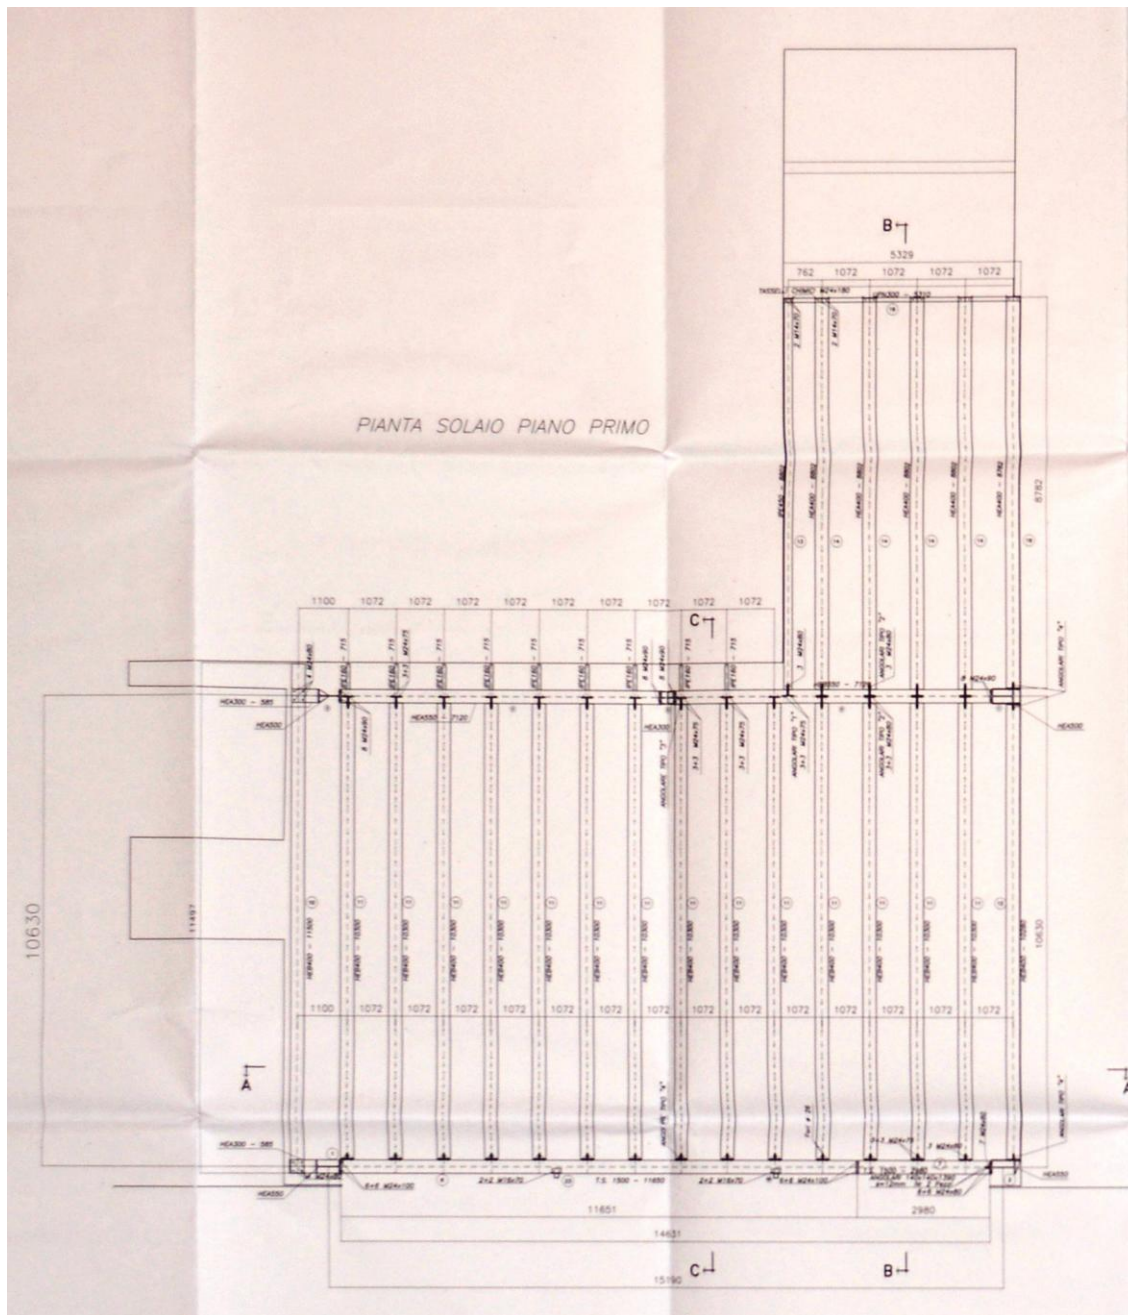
Particolare di A.2003.a.us.b.T04 - Pianta - Pianta piano primo
